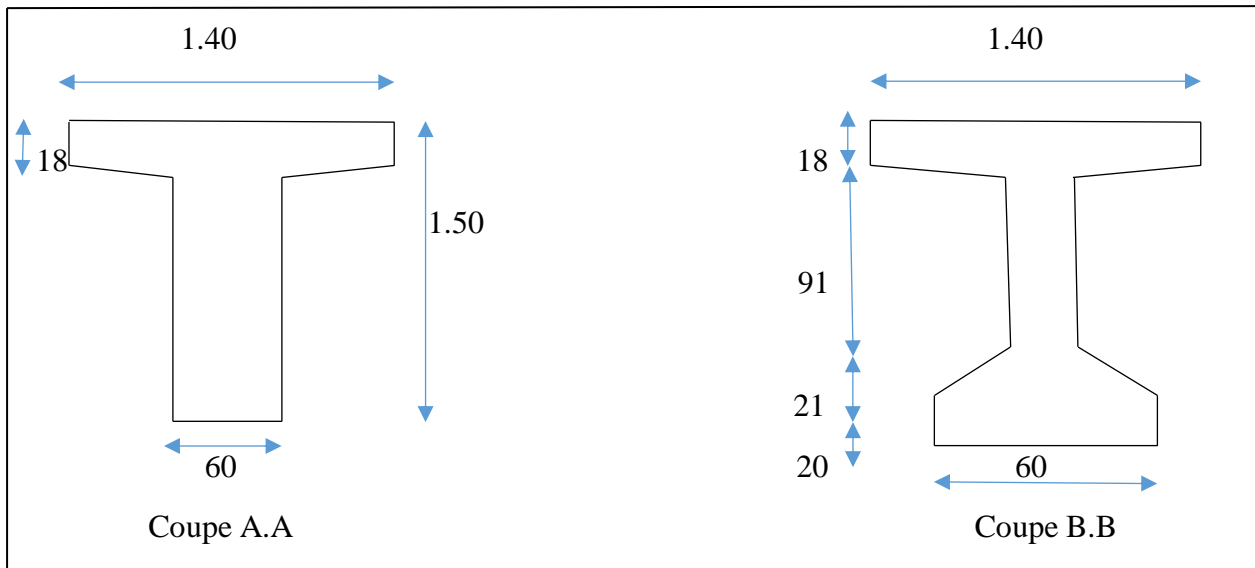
Coupes A.A et B.B des poutres du tablier du pont
